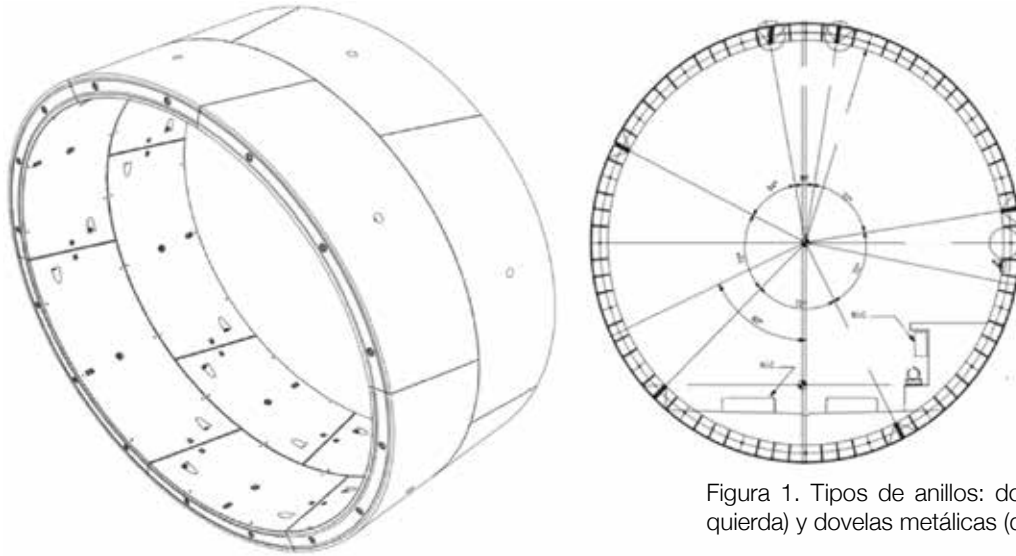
Tipos de anillos: dovelas de hormigón armado (izquierda) y dovelas metálicas (derecha)
